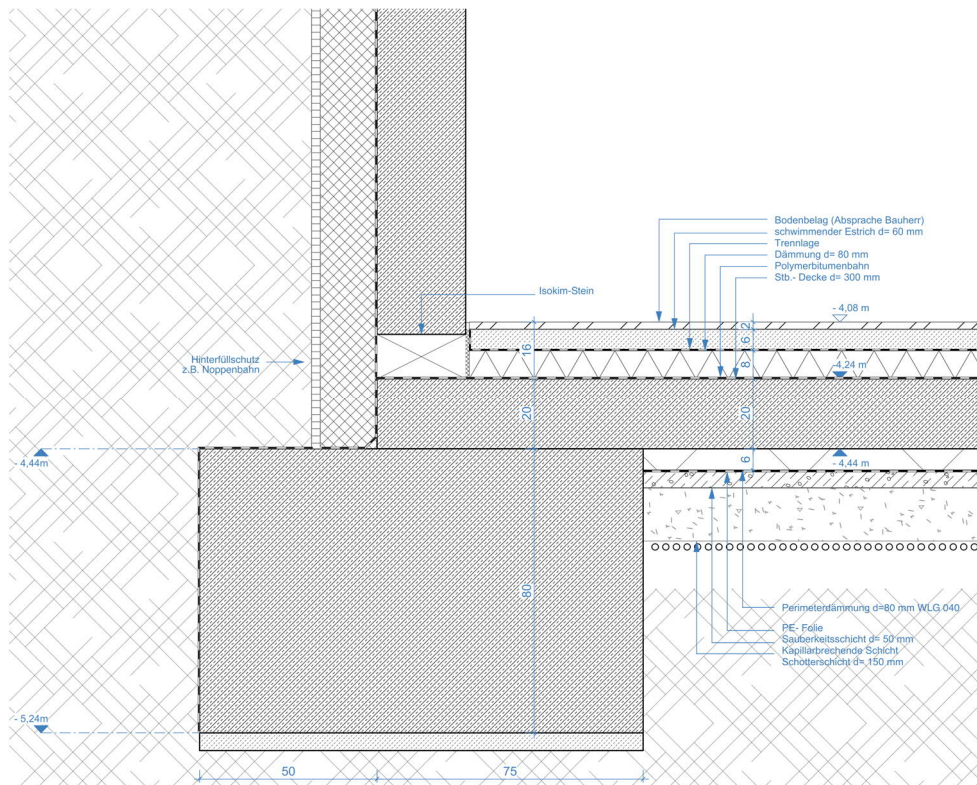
Detail Gründung/Bodenplatte_ursprüngliche Planung
